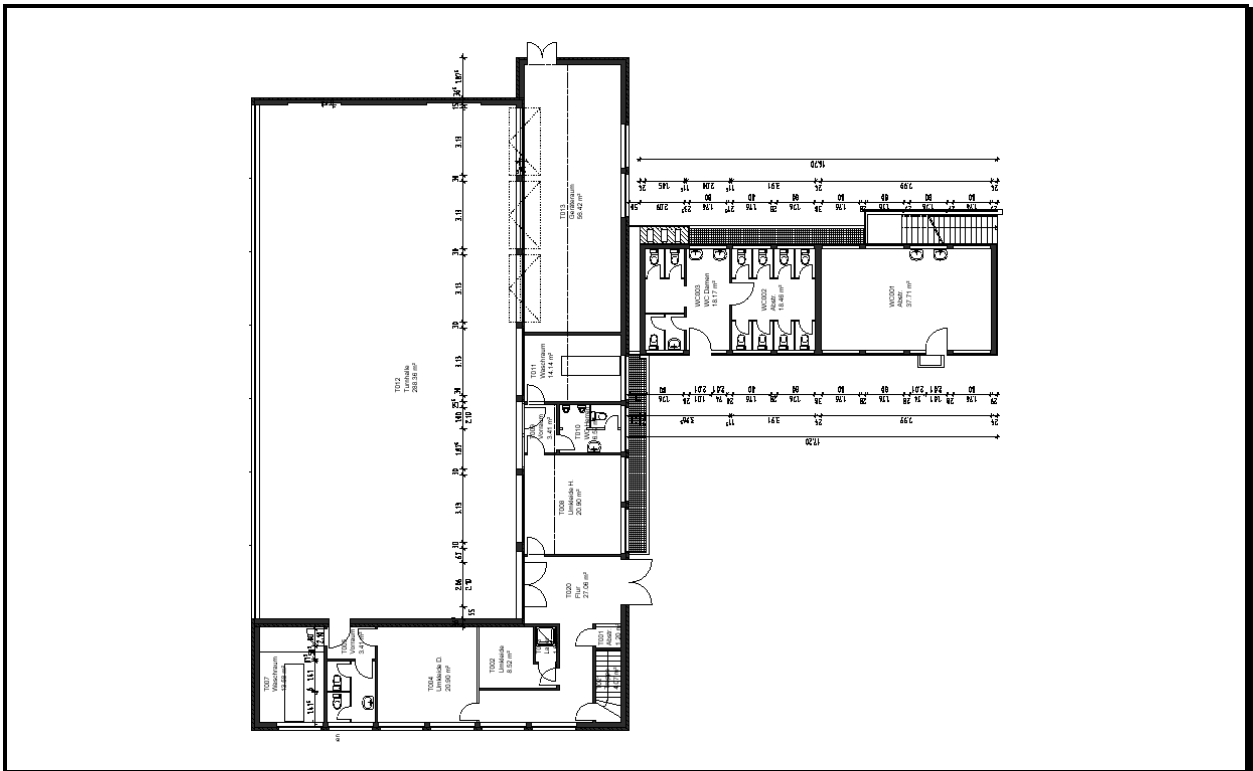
Brüder-Grimm Schule: Grundriss Turnhalle
